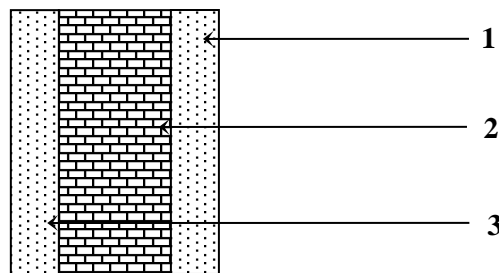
Coupe verticale d'un mur extérieur.
